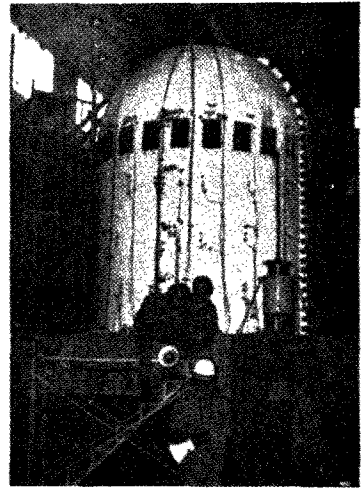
Prestress導入後의 試驗体 Jackdown (設置)
